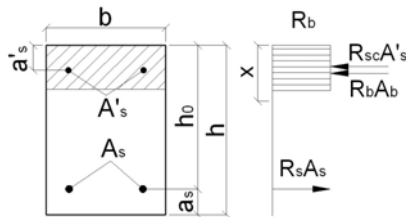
Схема усилий и эпюра напряжений в сечении, нормальном к продольной оси изгибаемого железобетонного элемента
